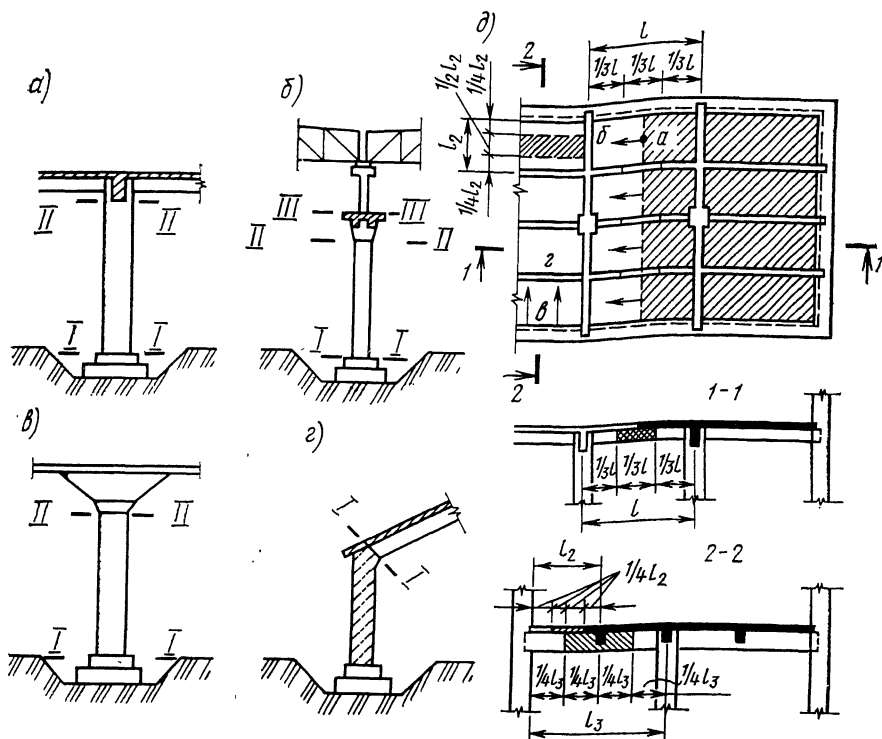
Расположение рабочих швов при бетонировании монолитных железобетонных конструкций
